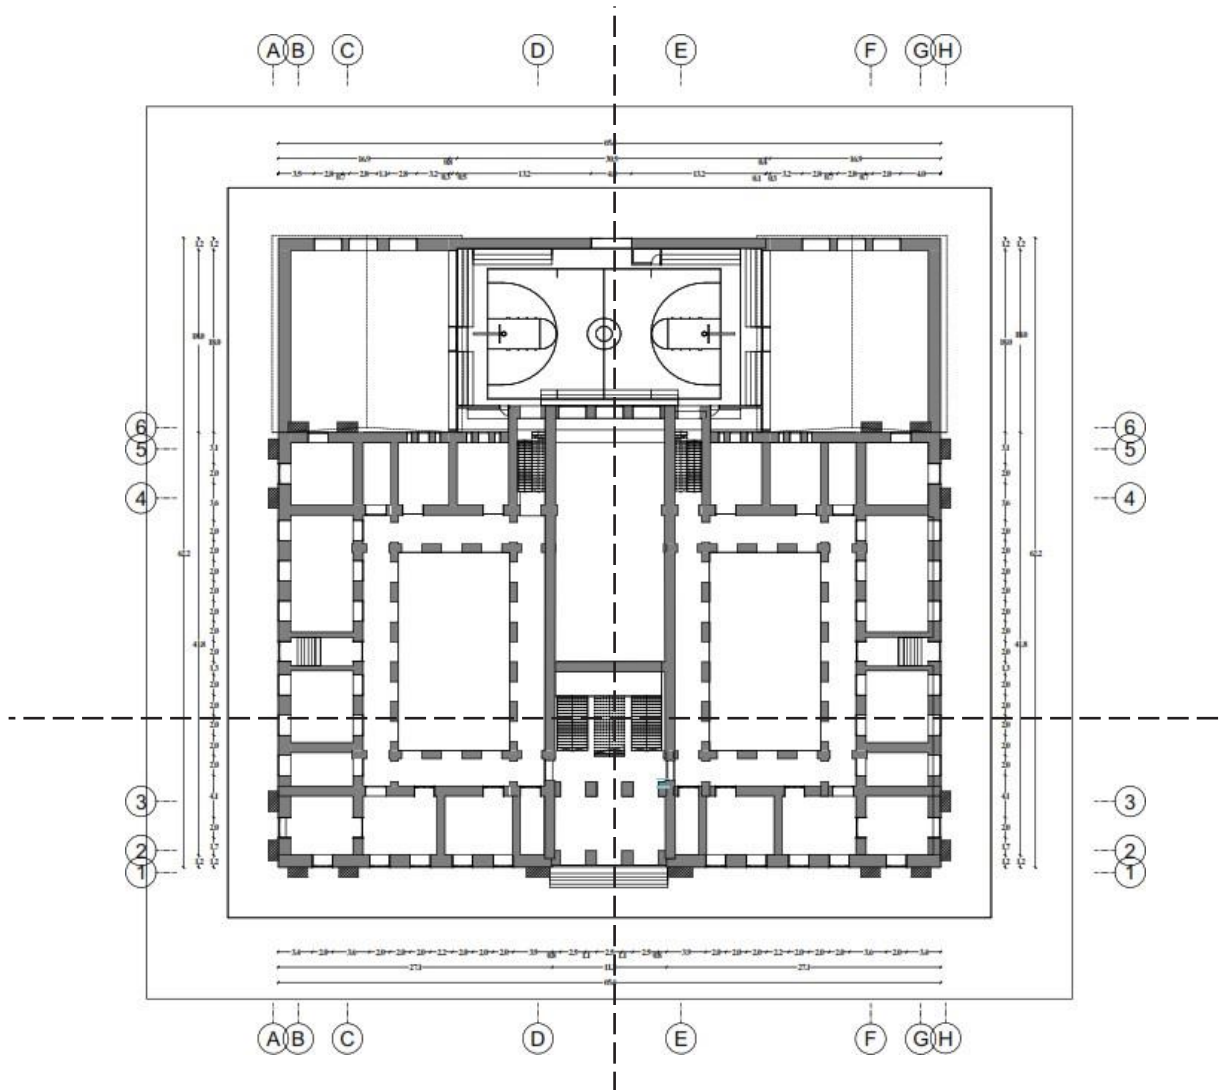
Planta baja del Inmueble - Colegio Maldonado
